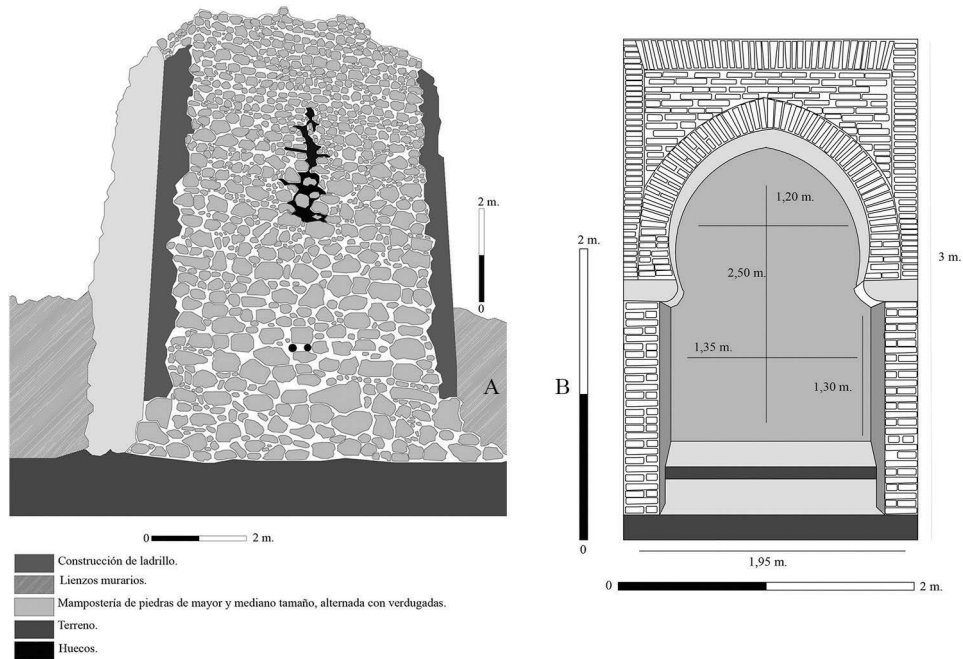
(A): Alzado sureste exterior de la puerta del Sol antes de la restauración. El segundo cinturón de las murallas. La técnica constructiva es mampostería concertada de piedras de diferente tamaño y verdugada con ladrillo y piedras, y refuerzo de ladrillo en sus esquinas. (B): La puerta del Sol, la entrada en la fachada noreste.
